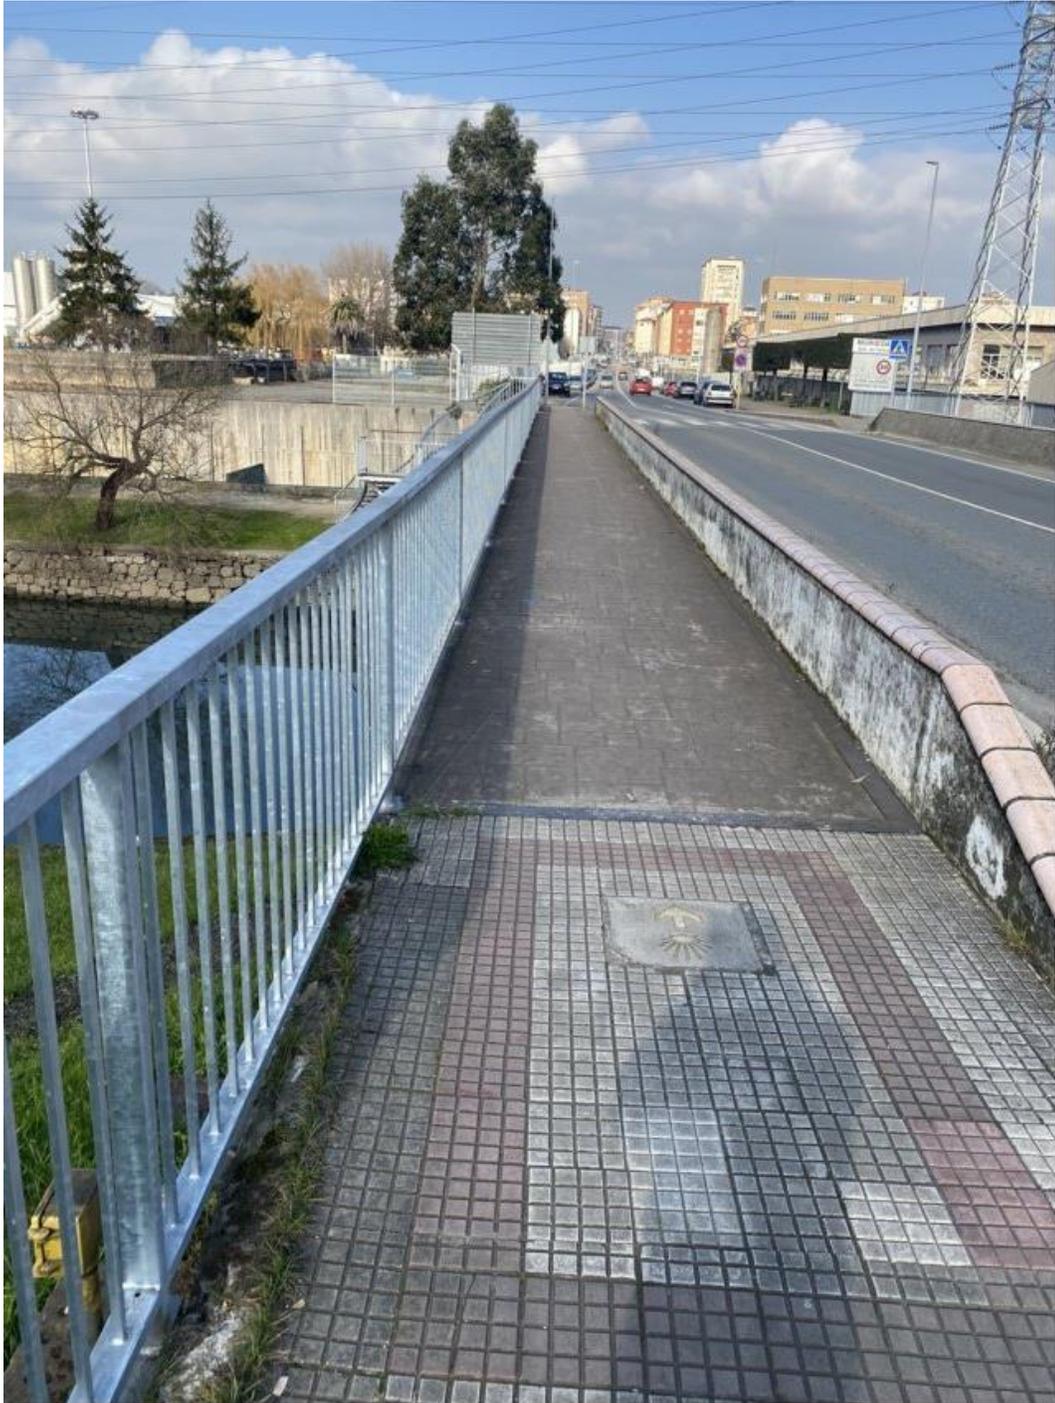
Detalle del puente por donde discurre la infraestructura canalizada existente
